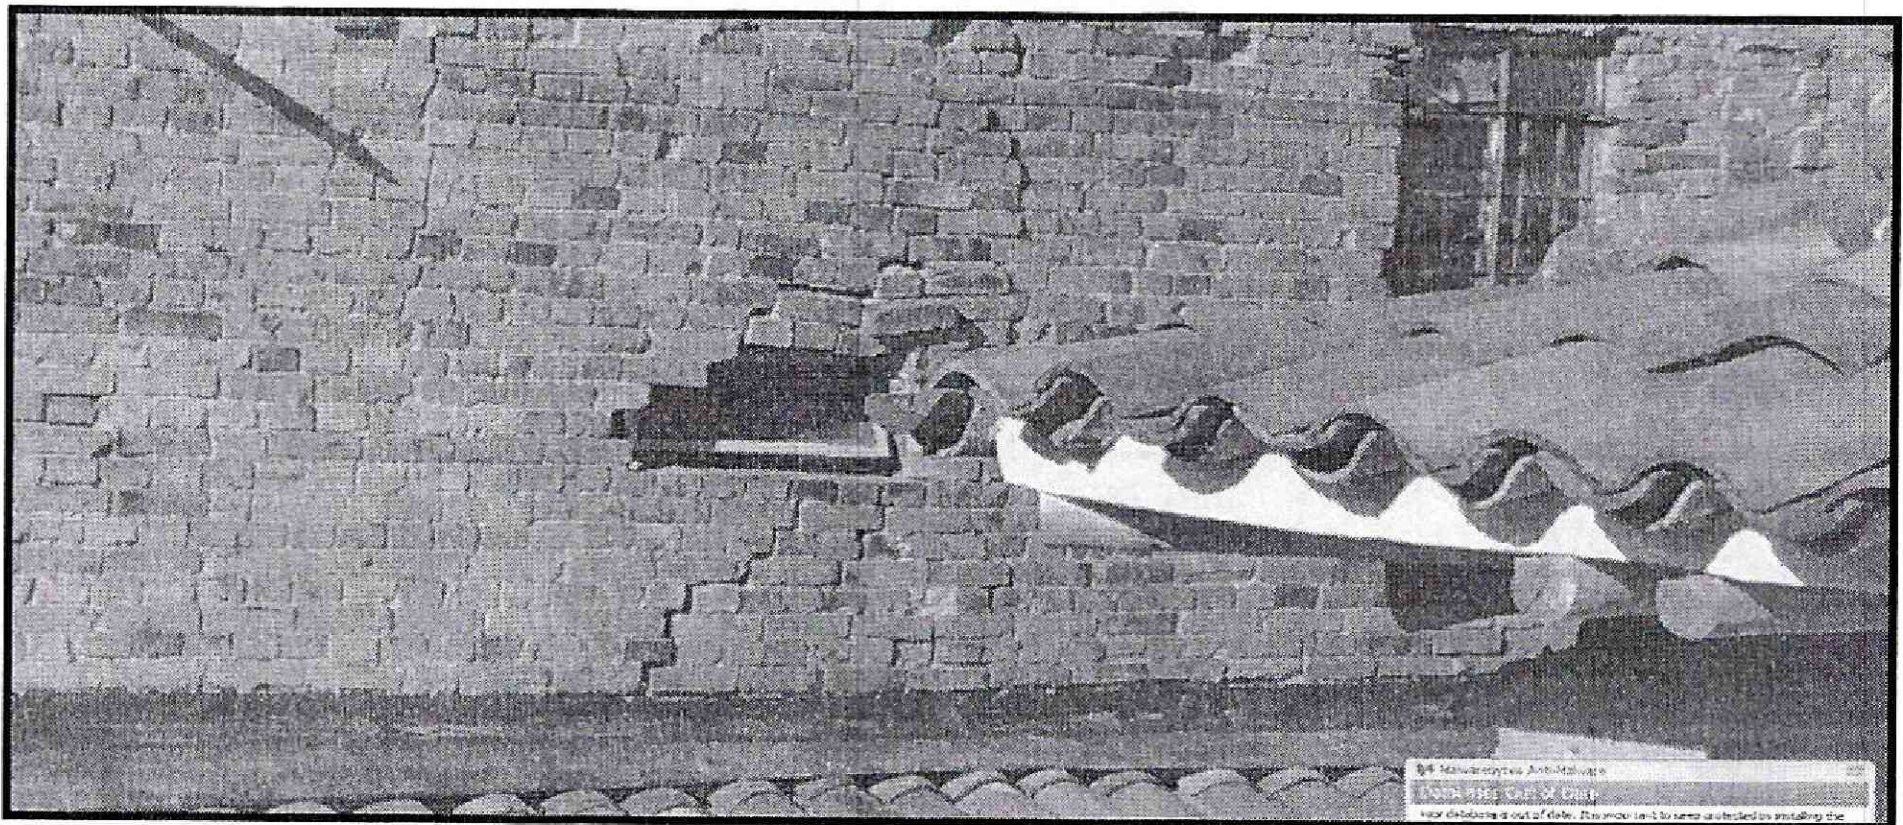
Flanche para la protección de goteras instalado sobre la cubierta de las oficinas del segundo nivel del costado nor-oriental del ministerio de vivienda
